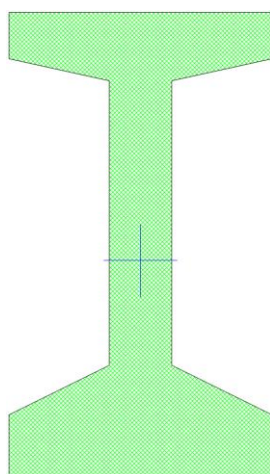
Sección de la viga doble T dimensionada con la herramienta Section Designer
